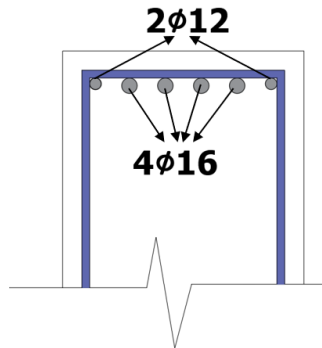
Disposición de armadura negativa en la viga.
